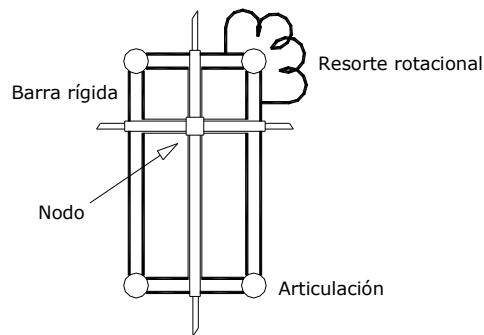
Detalle del modelo de Krawinkler.
